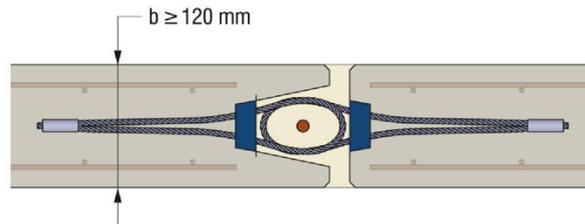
Wand – Wandverbindung (*planer Einbau*)
